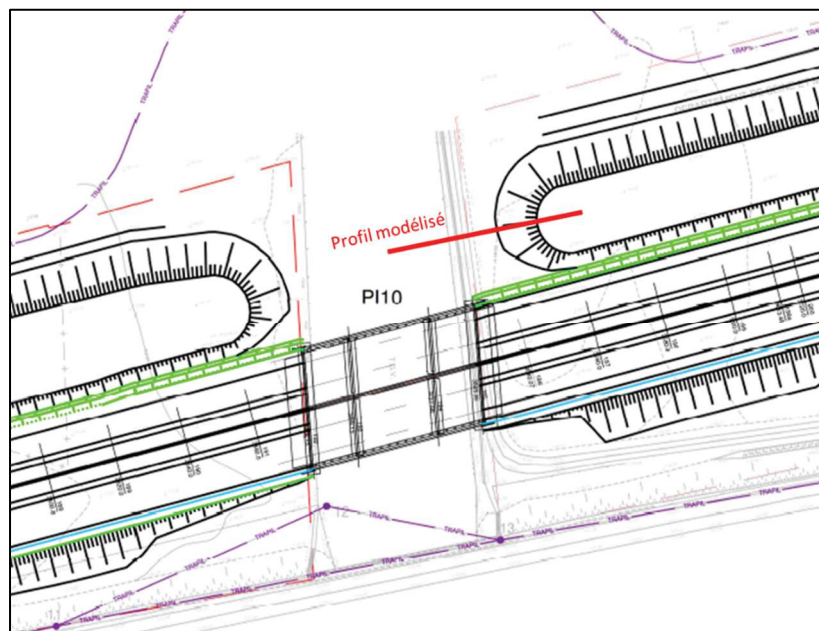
Extrait de la vue en plan de la tranche TO2 et localisation du profil modélisé au niveau de l'ouvrage PI10
